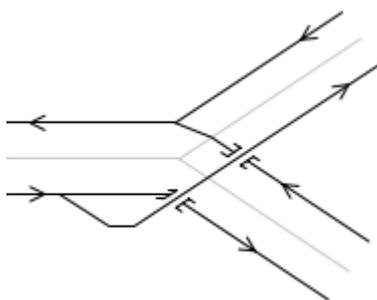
Schematische Darstellung Streckenverzweigung (höhenfrei)/ Verschlingung bei zwei 1-gleisigen Tunnelröhren (alternative Lösung mit Führung der durchgehenden Tunnelröhren in gleicher Höhe)
